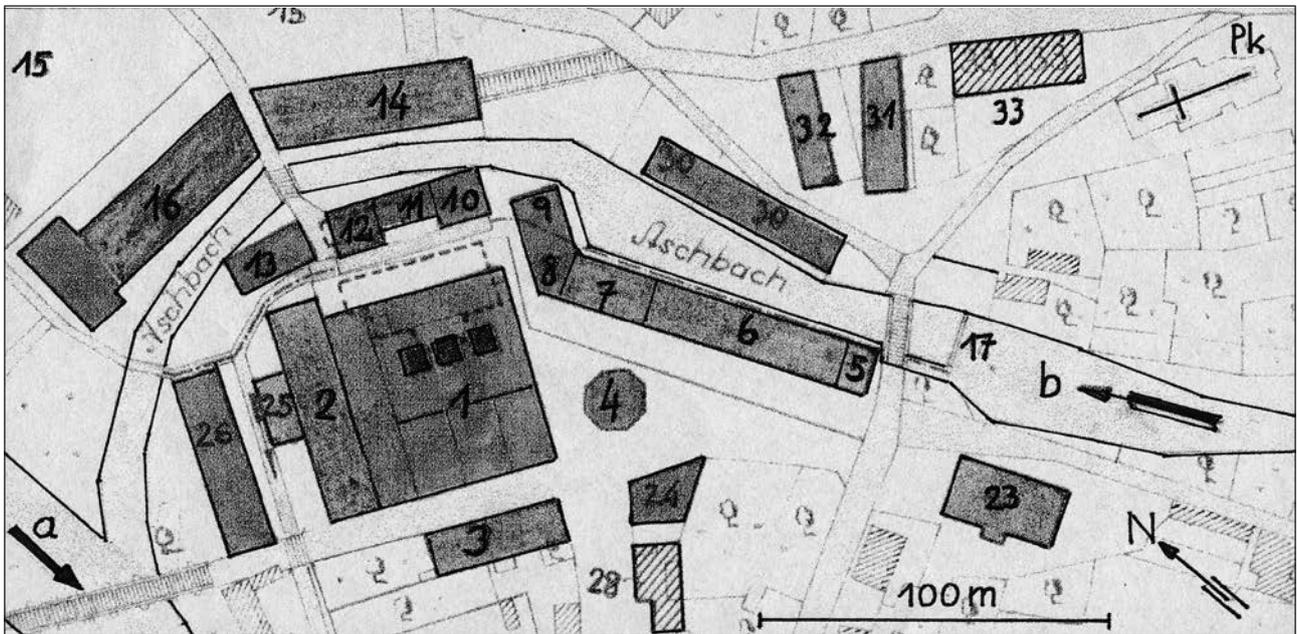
Lageplan der Hüttenanlagen und anderer Gebäude in Gusswerk.
